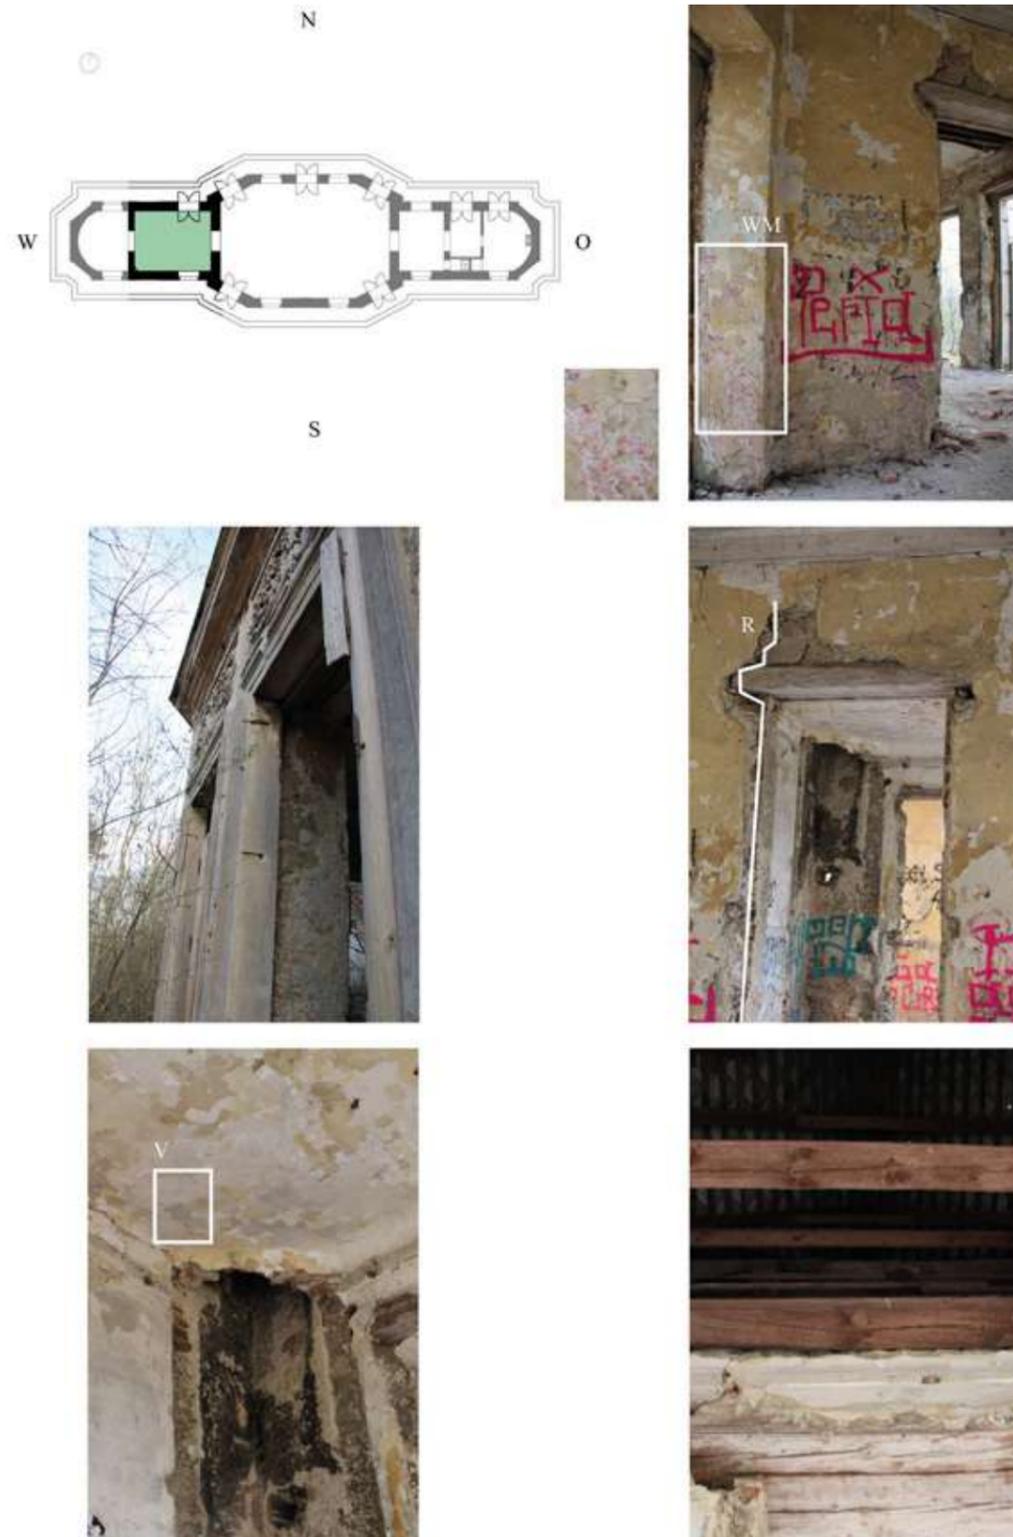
Lage im Grundriss, Übersicht des Zimmers mit Blick in den Salon, Außenansicht der Fensteröffnung, Fassadenansicht, Ansicht Türrahmen mit Holzbalkensturz, Großaufnahme des Kaminöffnung, Deckenschäden und Blick in den Dachstuhl
